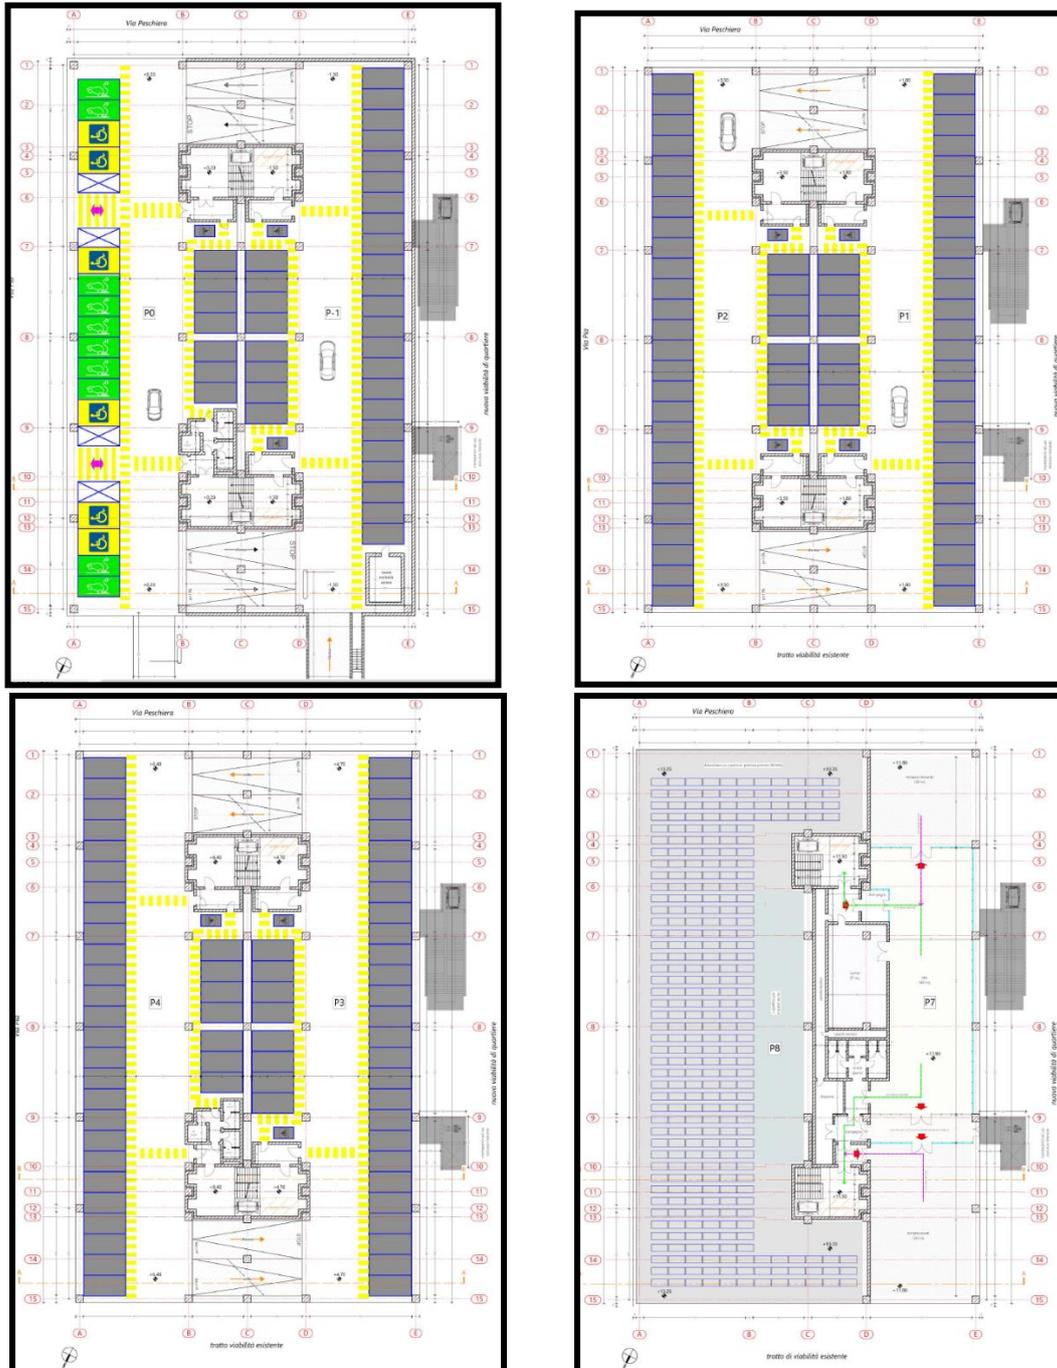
stralcio della planimetria dei diversi piani dello stabile in progetto
